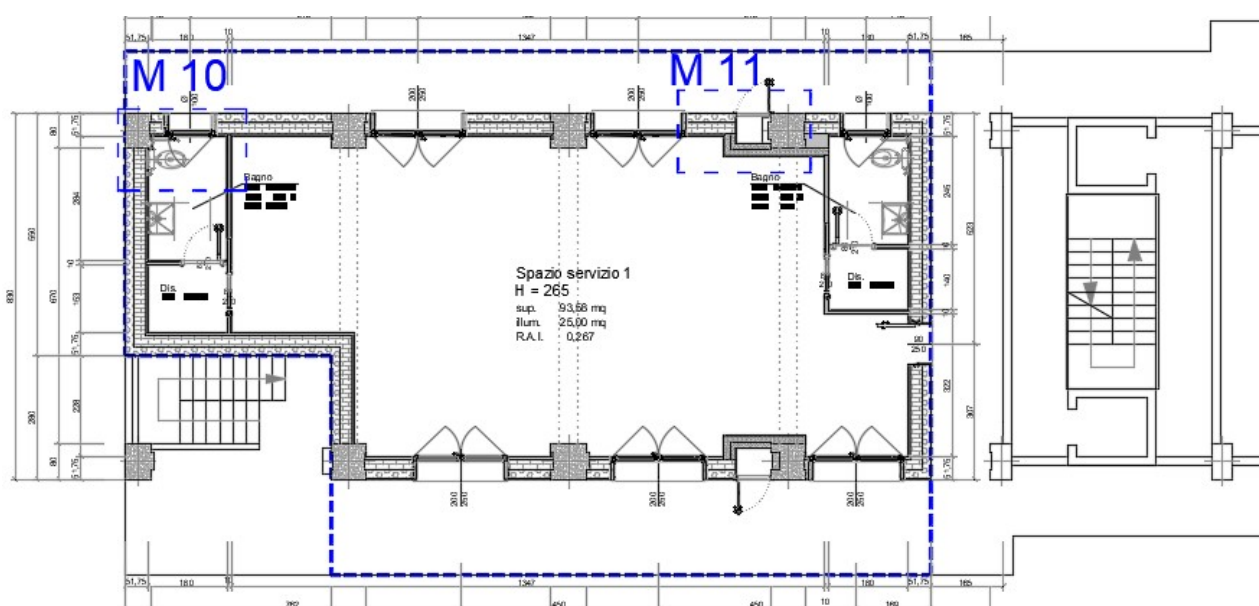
Estratto progetto di chiusura del piano terra di via Marinai-3
